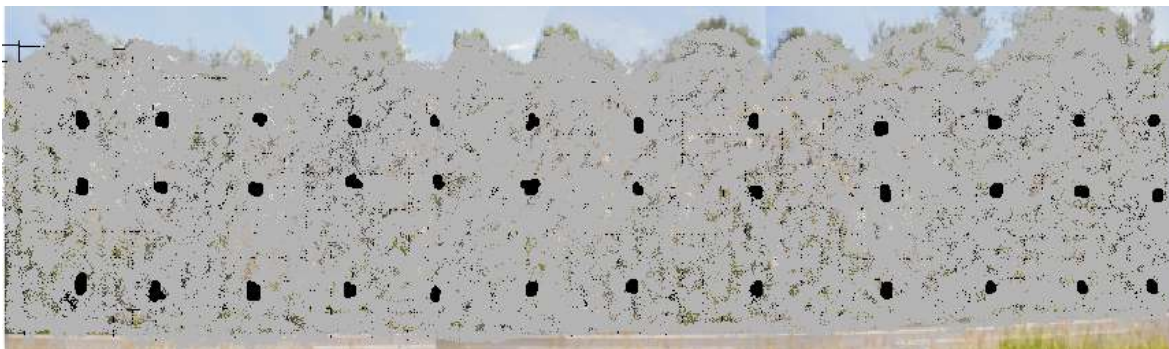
Concreto lanzado con sistema de anclajes pasivos para distribuir las cargas y drenes para el flujo de agua.
